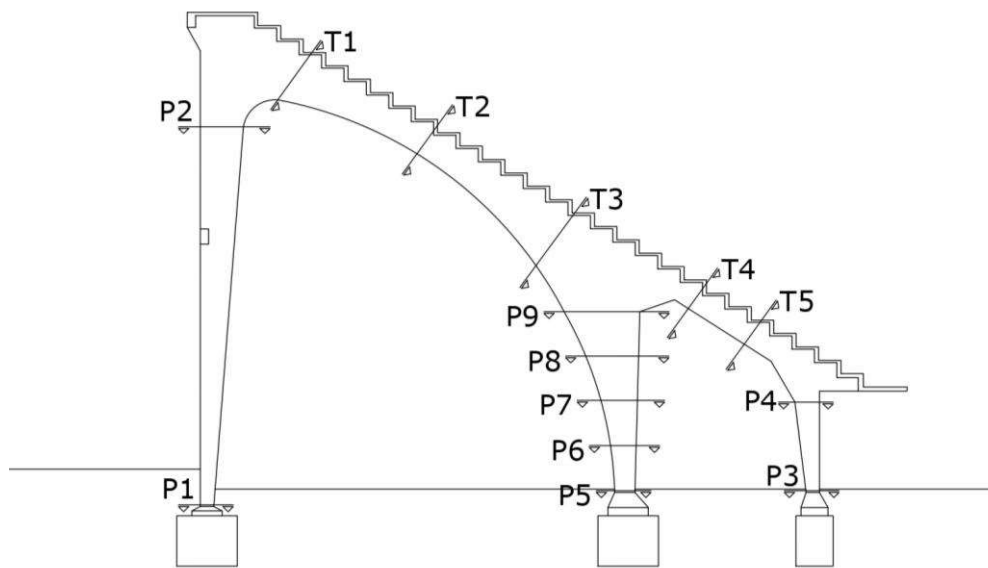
Telaio 5 con indicazione delle sezioni oggetto di verifica
